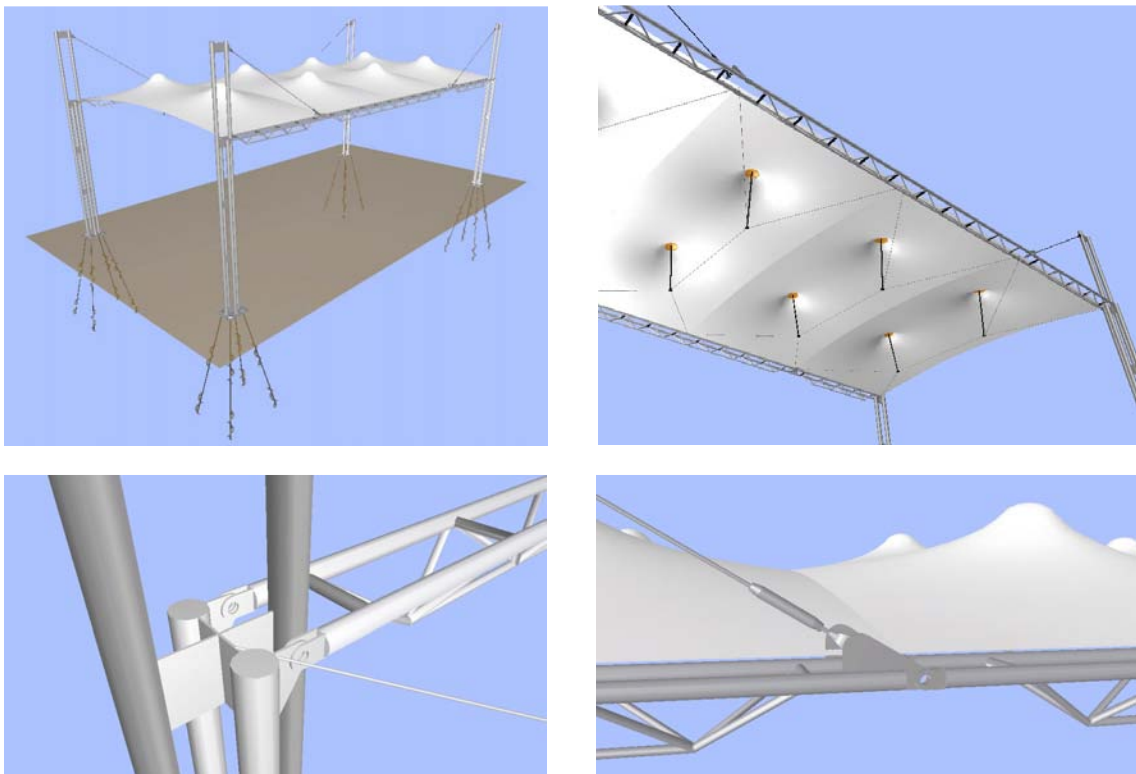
Tanto las vigas en celosía como la cubierta están atirantadas
